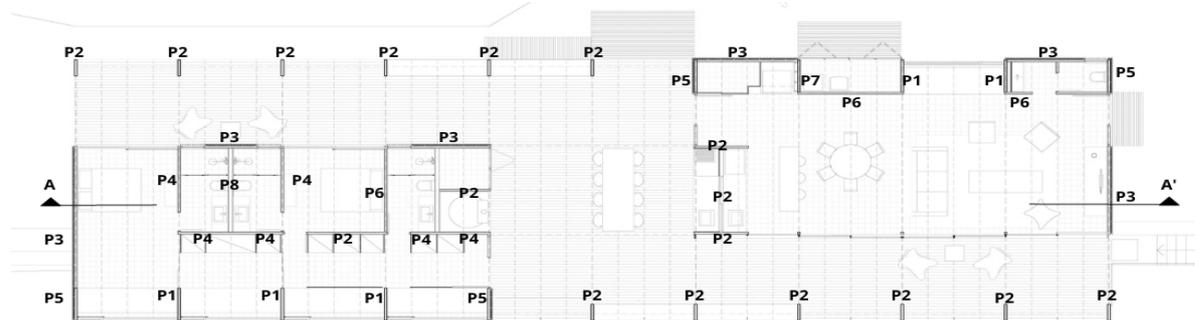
Planta simplificada com indicação dos tipos de paredes externas e internas, MAPA Arquitectos (adaptado), 2023
